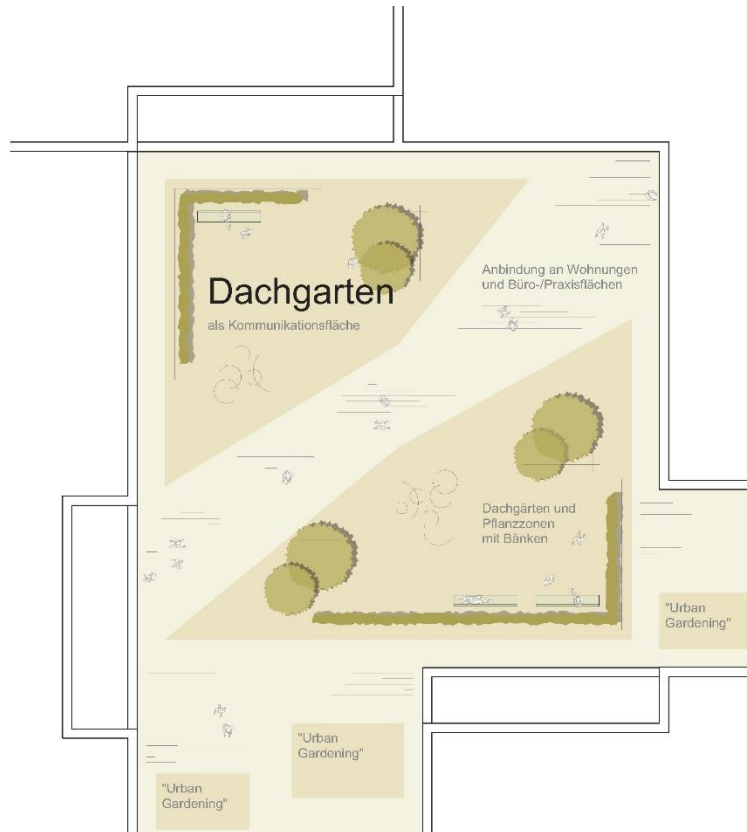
Gestaltungsplan | Dachgarten © LECKE ARCHITEKTEN
